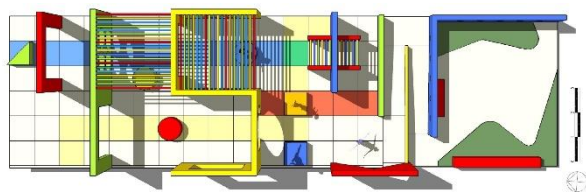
Espaço Lúdico, Planta baixa. Disponível em <<http://goo.gl/PxLFTk>> acesso em abril de 2014
